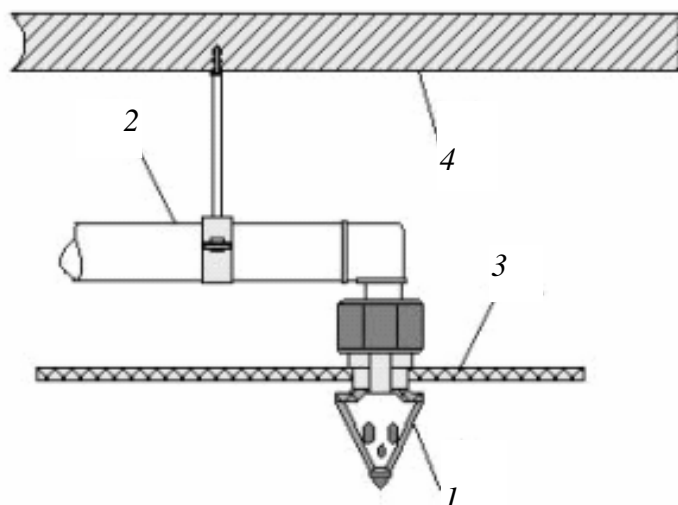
Типовая схема размещения выпускного струйного насадка в конструкции подвесного потолка:
